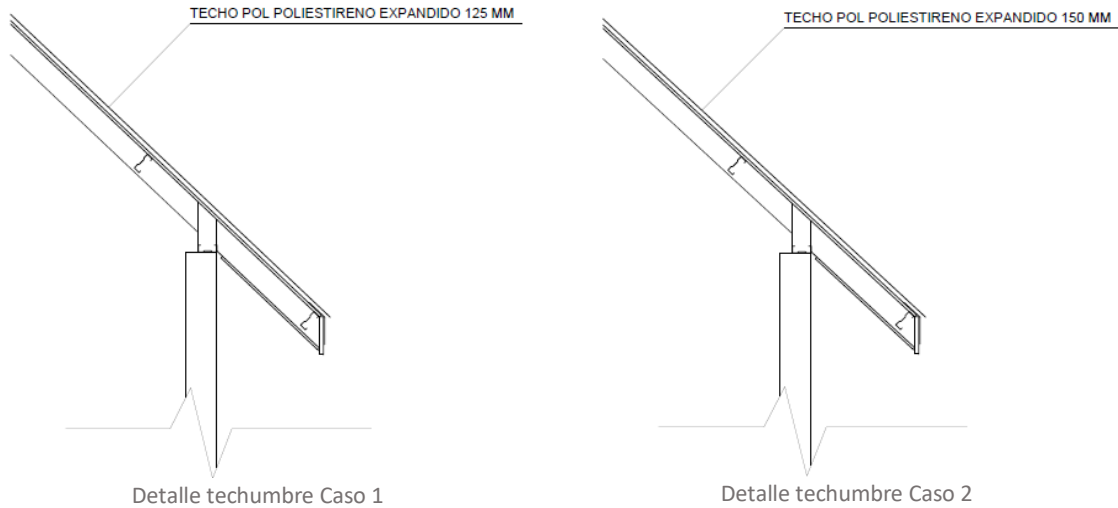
Detalles constructivos de la envolvente térmica del techo para ambos casos de estudio.
